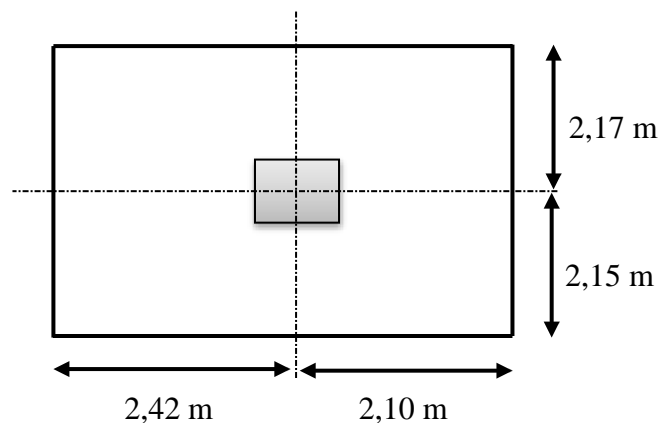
Section supporté par le Poteau le plus sollicité.
